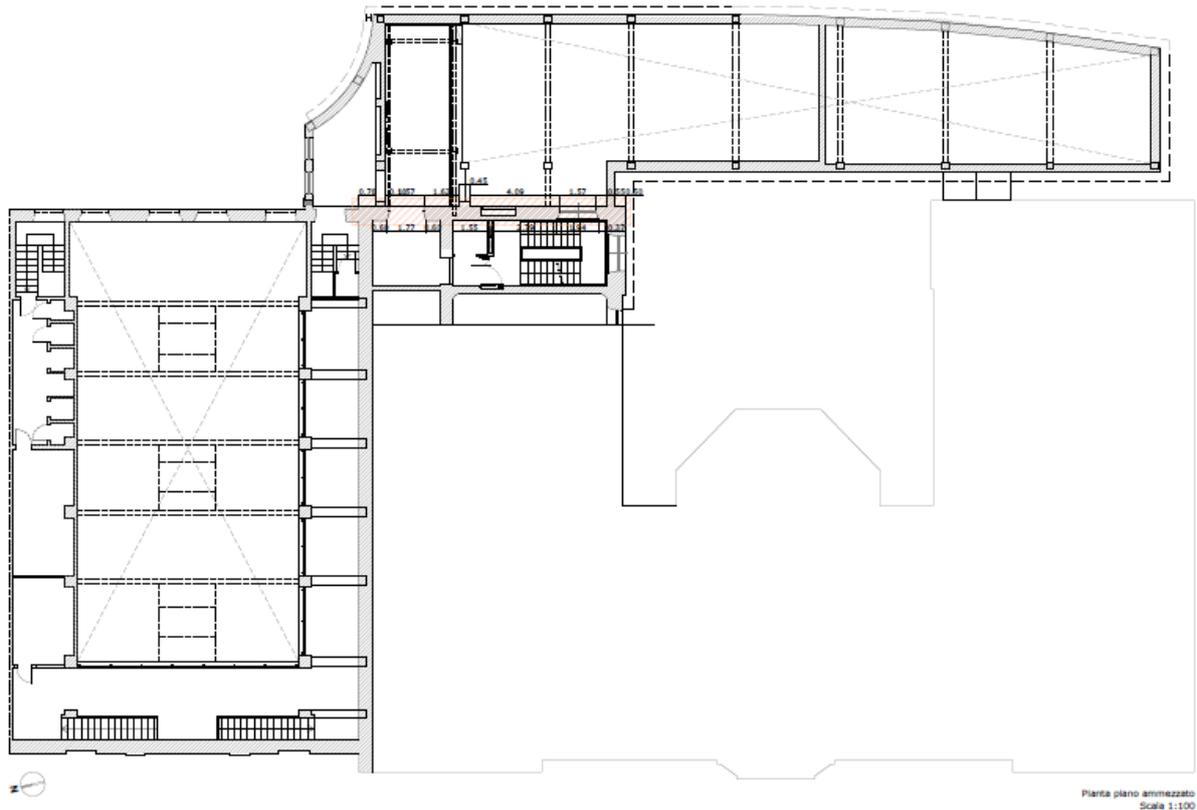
Pianta piano Ammezzato con indicazione delle zone di intervento
